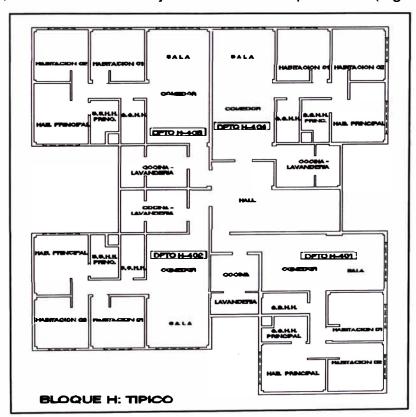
Esquema en planta de muros según la Arquitectura de un bloque
